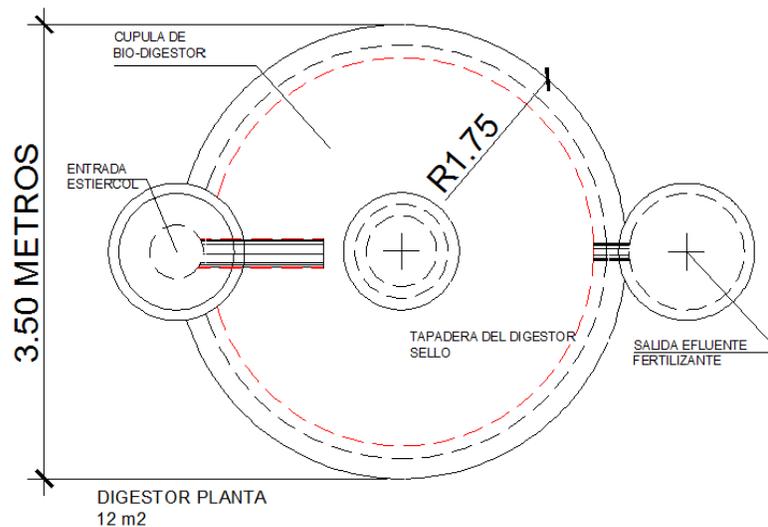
planta de Biodigestor. Fuente: Elaboración Propia
